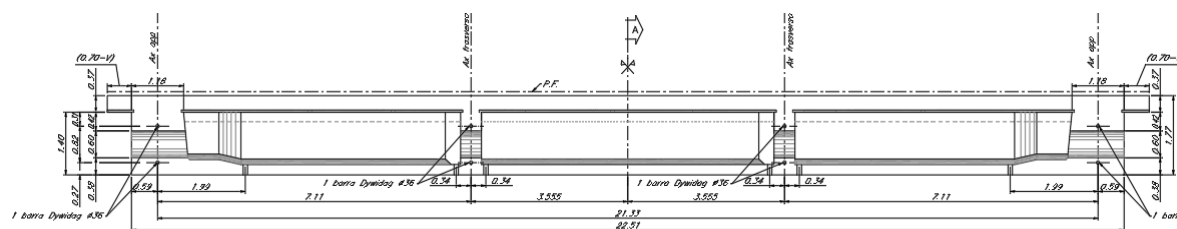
Cavalcaferrovia di via Wenner – Sezione longitudinale impalcato
